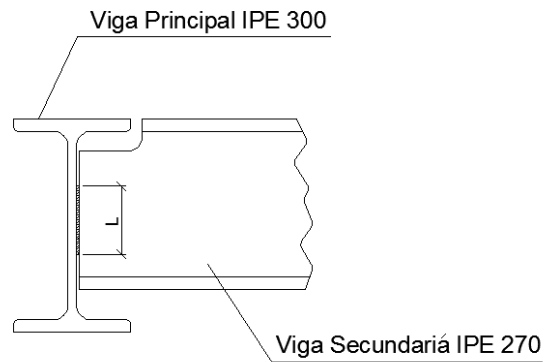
Pormenor de ligação soldada entre a Vigas.
